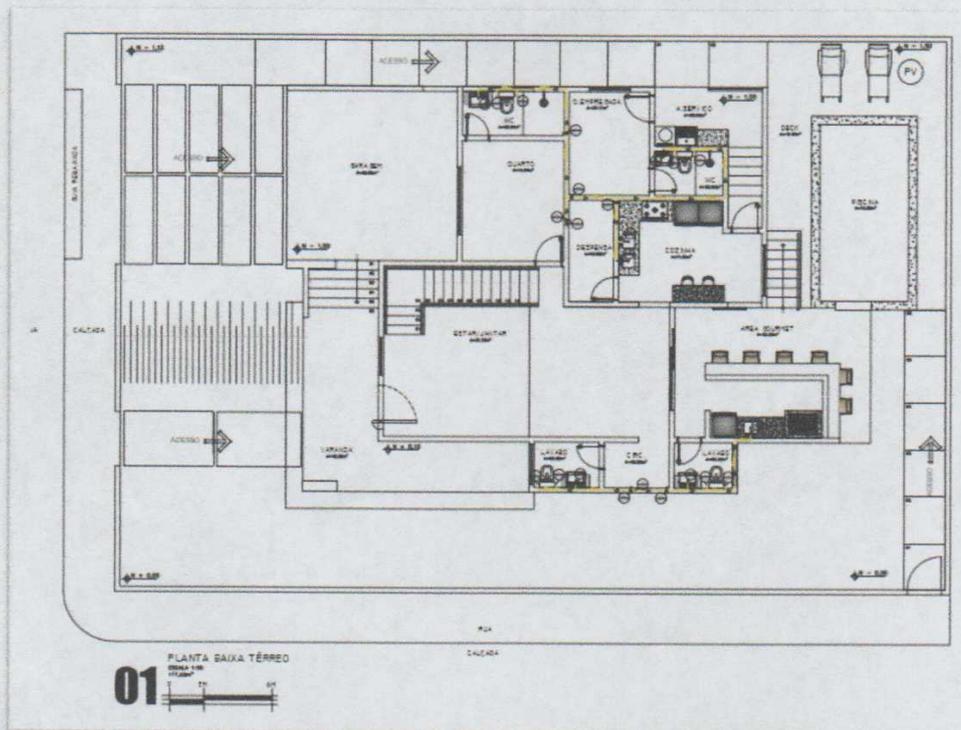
Planta baixa Térreo. Instalação predial de água fria.
